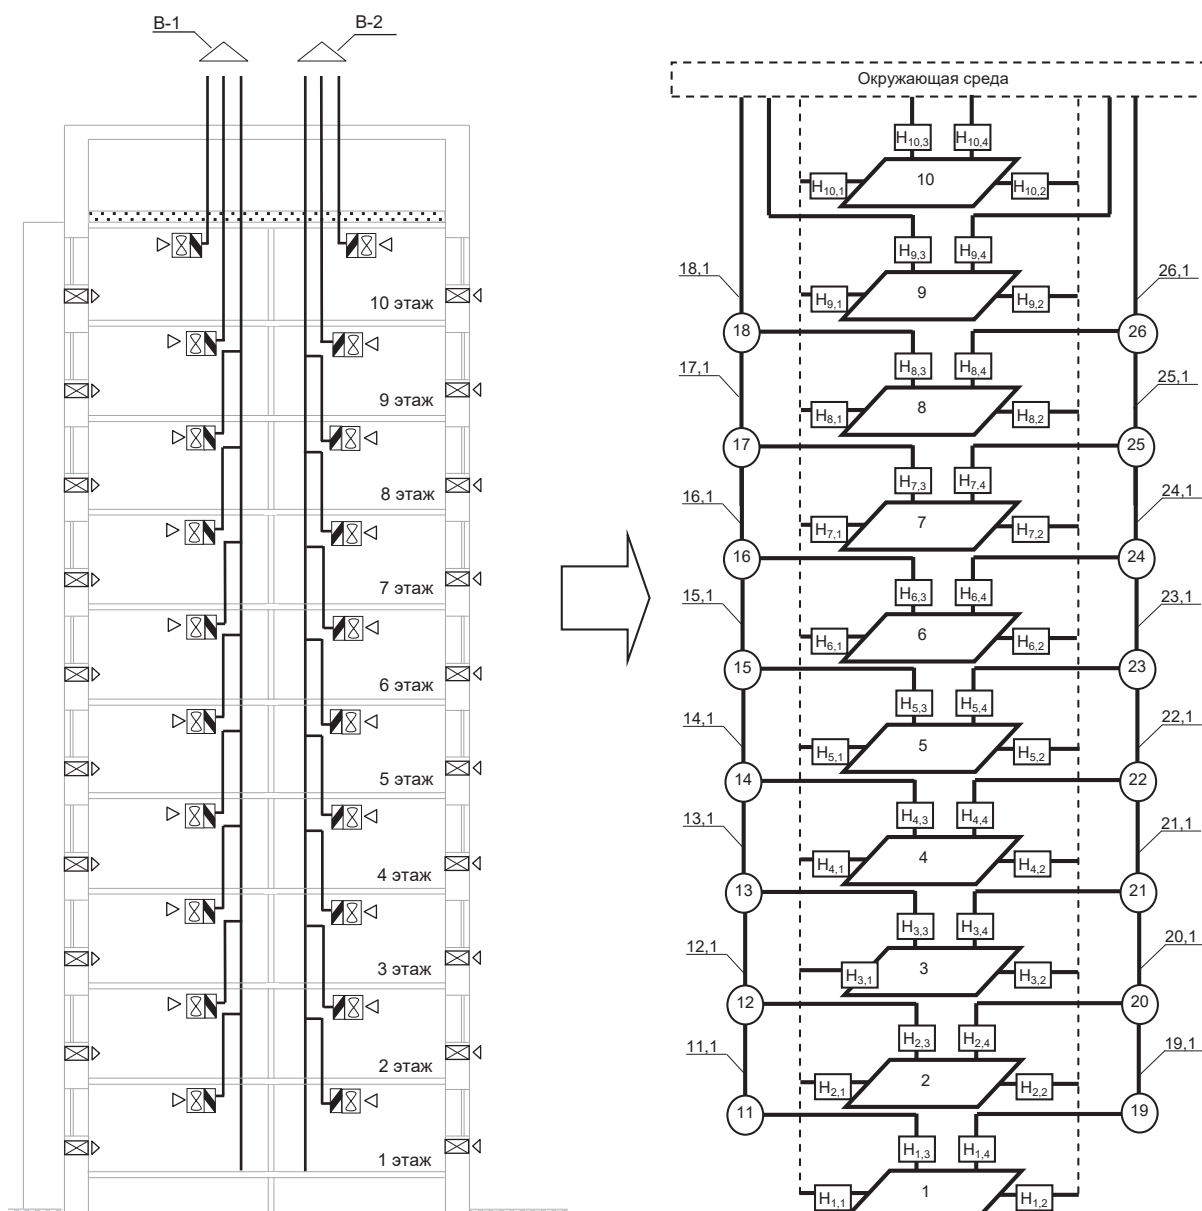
Расчетная схема и граф системы вентиляции десятиэтажного жилого дома с децентрализованным механическим удалением воздуха
